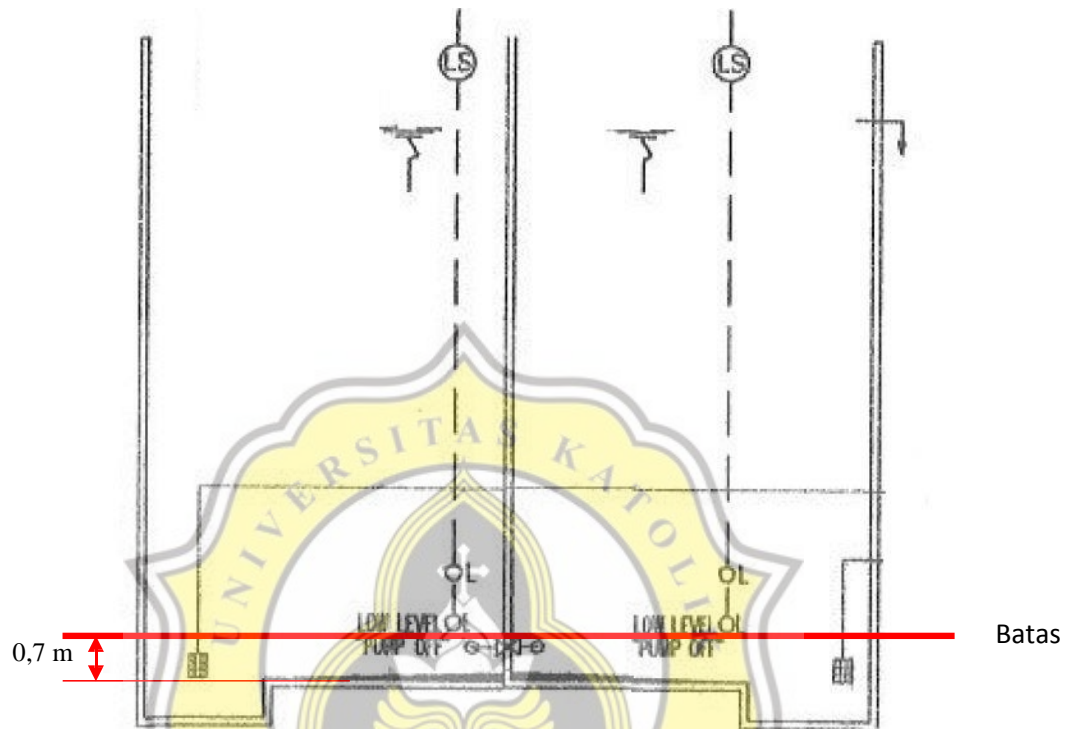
Tangki Penampungan pada Gedung “X” (Sumber: Diolah dari Gambar *For Construction* Gedung “X”)
